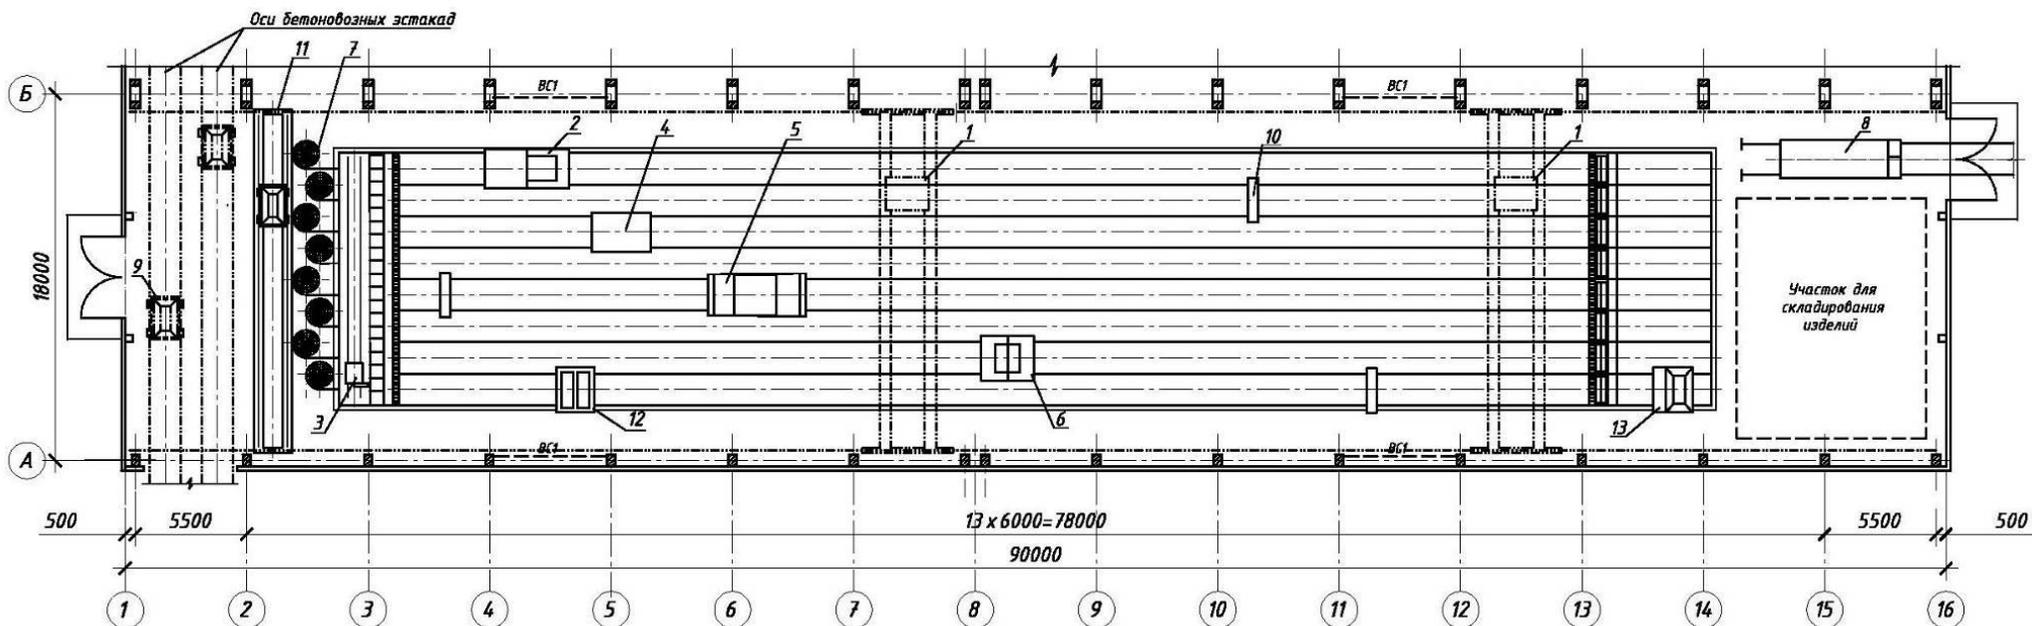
Производство многопустотных плит перекрытия по безопалубочной технологии:
